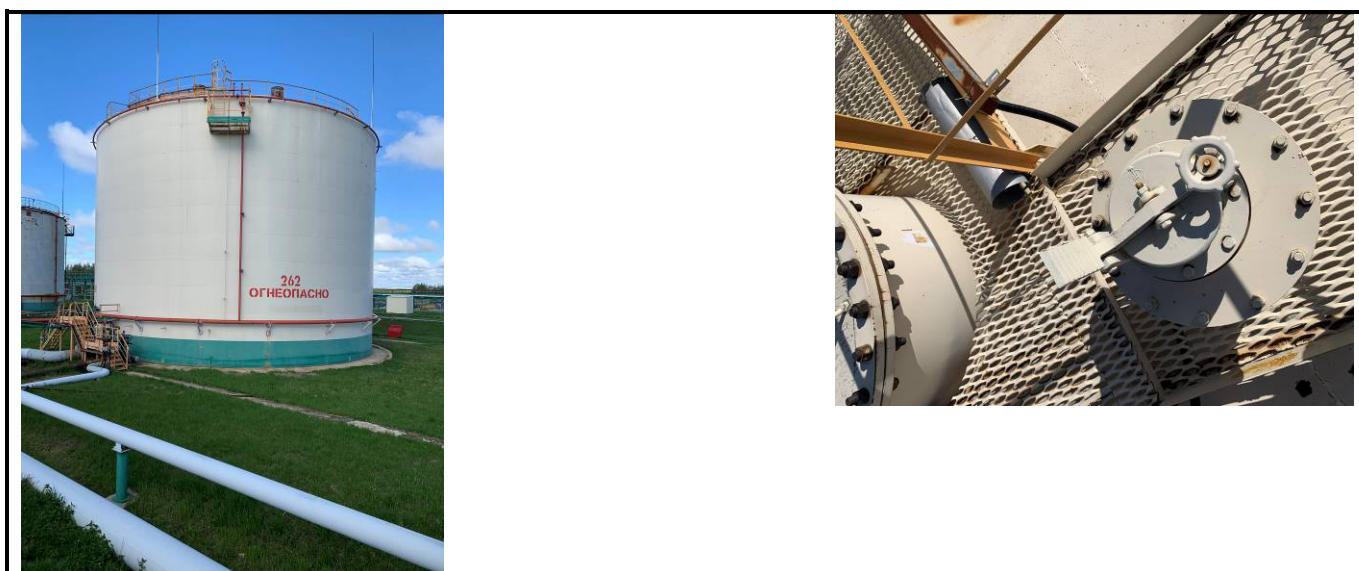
Общий вид резервуара РВСП-5000 (№262) с замерным люком
